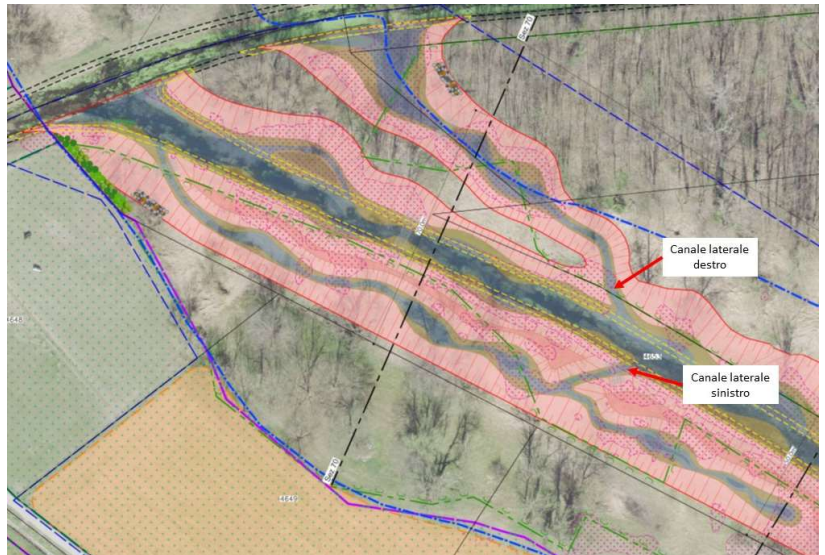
Estratto planimetrico del *bypass* e del braccio laterale in sponda sinistra.
